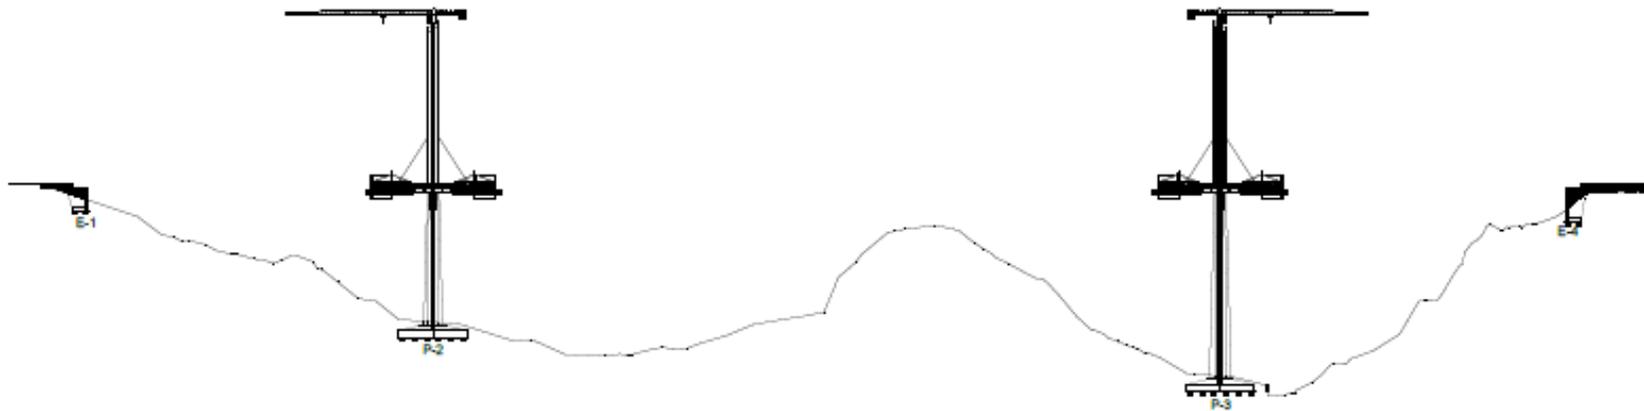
Fase 7: Construcción de dovelas de la superestructura
